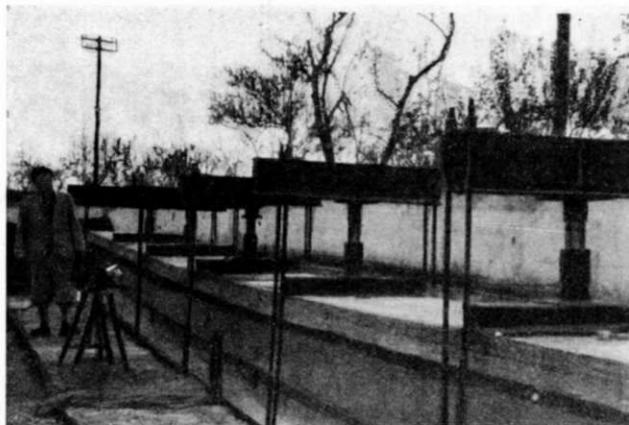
Collaudo dell'impalcato sperimentale con T.A.S. profilo 52.
